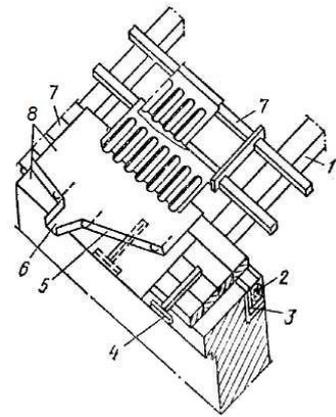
Фрагмент кровли из пазовой штампованной черепицы: 1 – стропильная нога; 2 – мауэрлат; 3 – толь; 4 – костыли; 5 – настенный желоб; 6 – лоток; 7 – обрешетка; 8 – кровельная сталь
